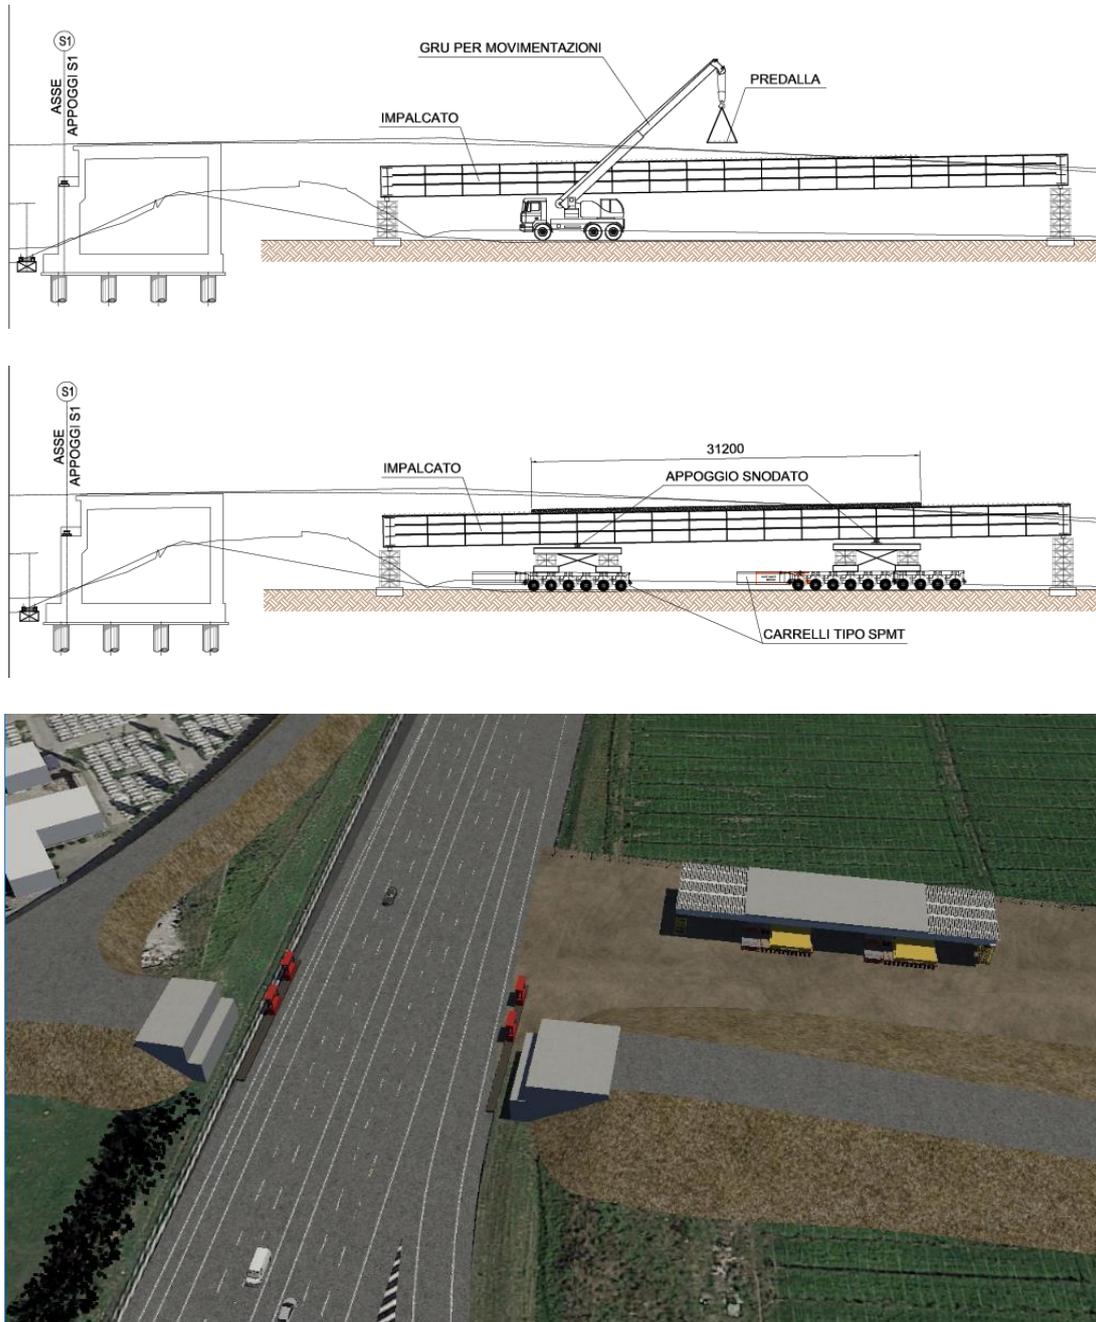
Fase a montaggio ultimato su appoggi provvisori, posa predalles e getto parziale di soletta
